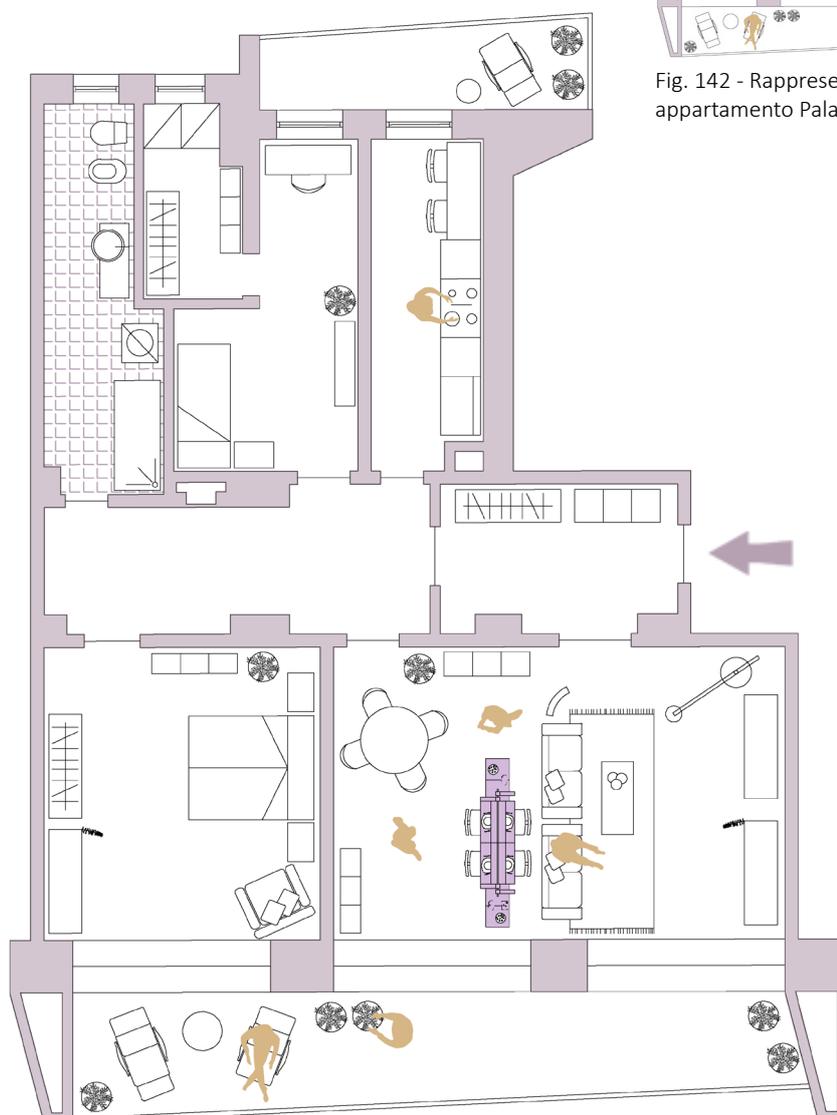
Rappresentazione planimetrica soluzione ambiente conviviale.
